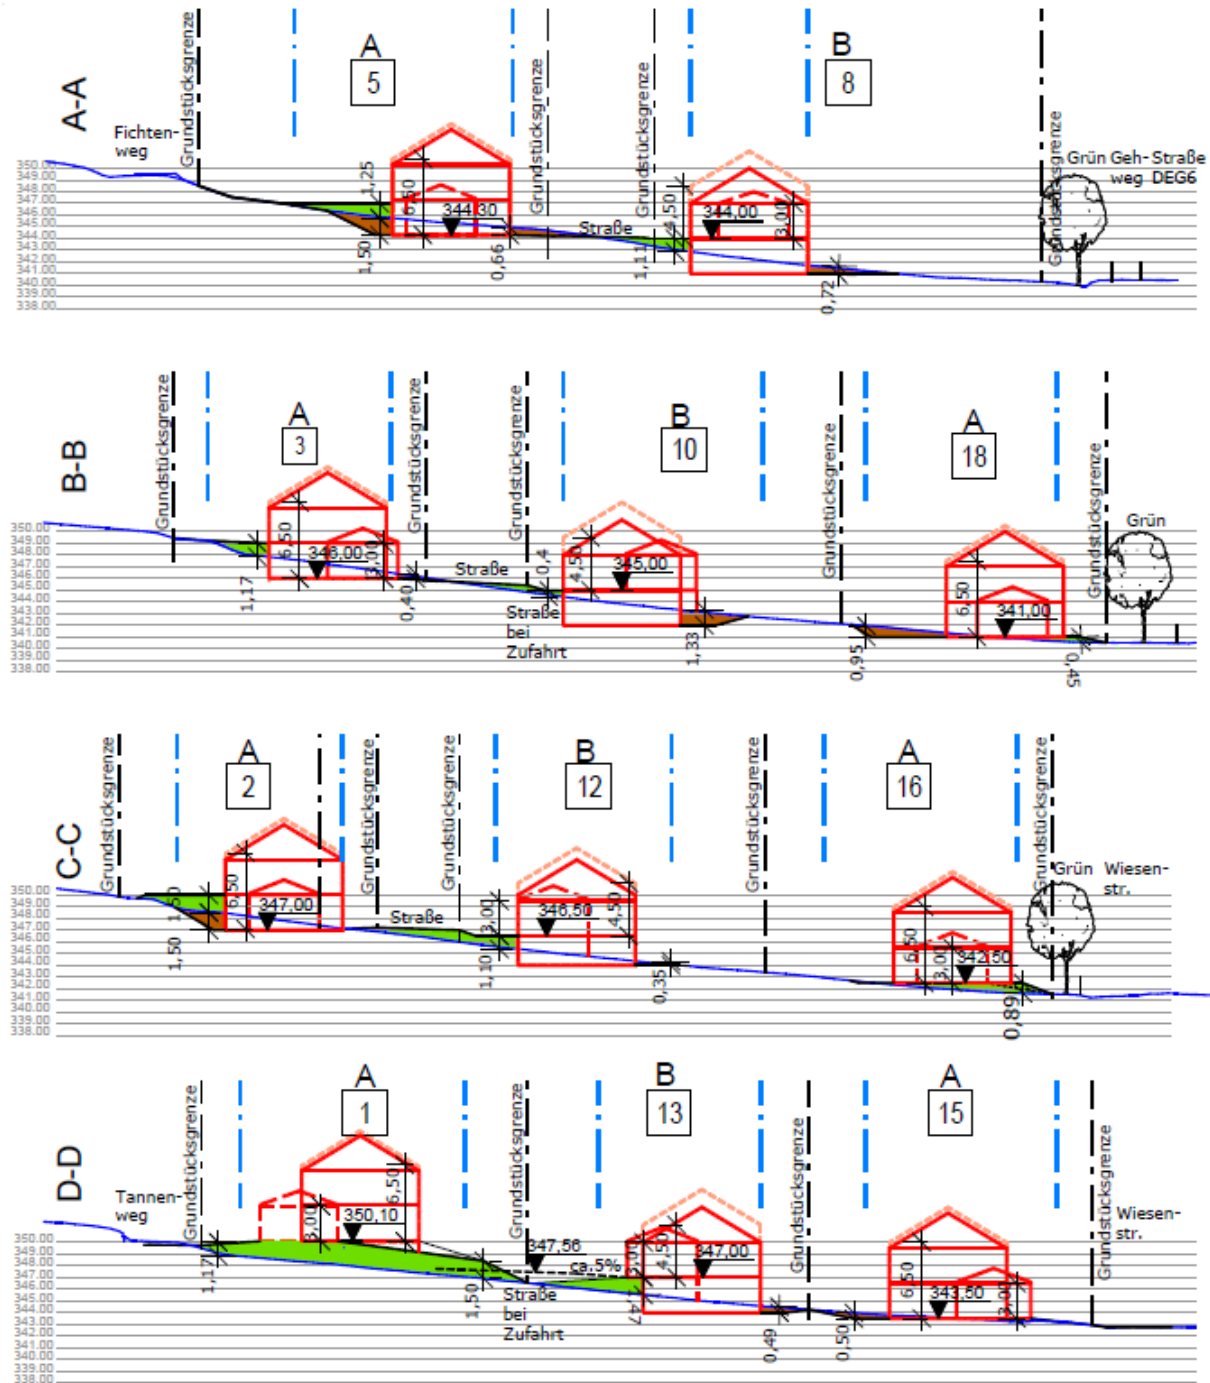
Auszug aus Beiplan zum Bebauungsplan - Systemschnitte, Büro Jocham + Kellhuber GmbH, Iggensbach; Darstellung unmaßstäblich
